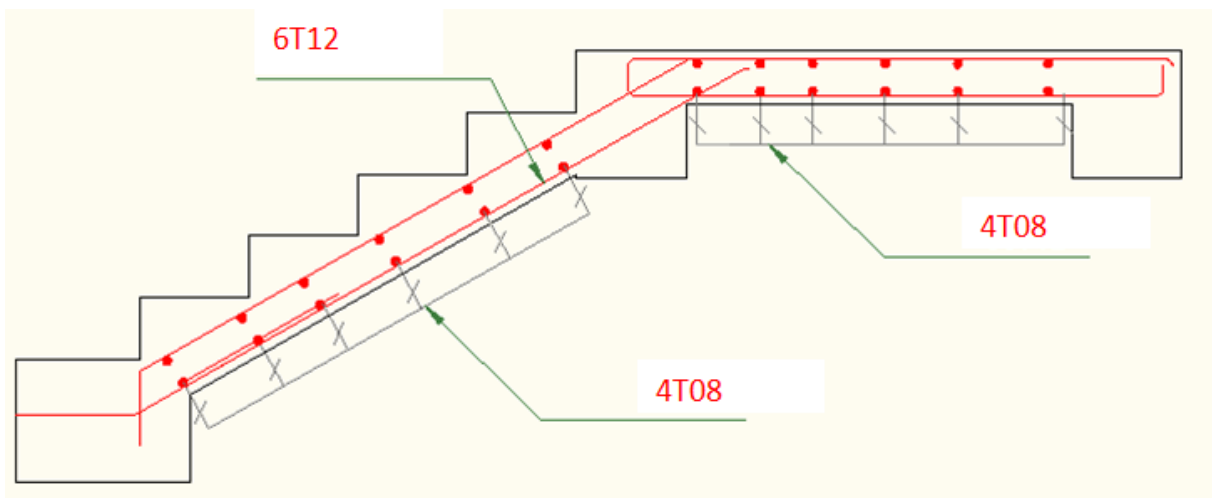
Schéma de ferrailage de l'escalier d'étage courant
